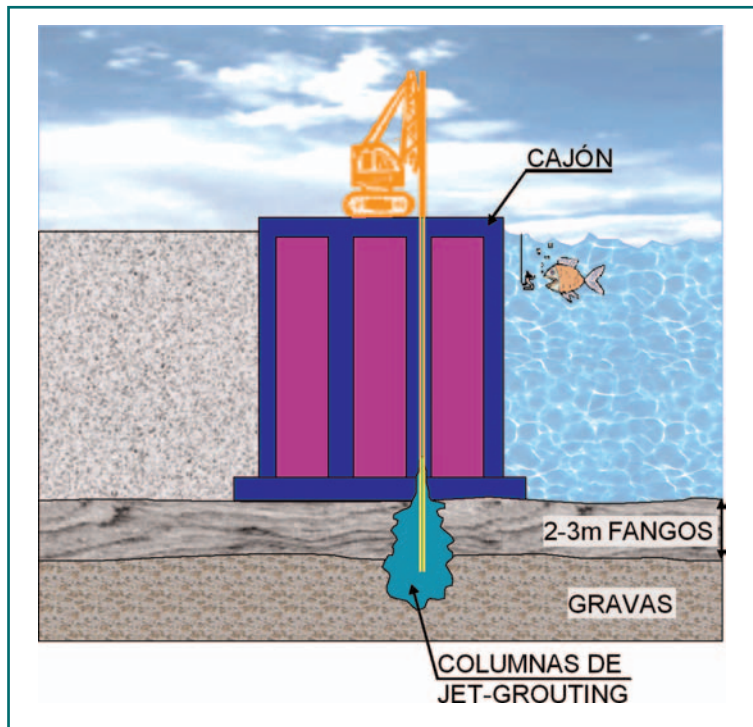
Recalce de cajones en el Puerto de Málaga con jet-3 para reforzar los fangos existentes.
